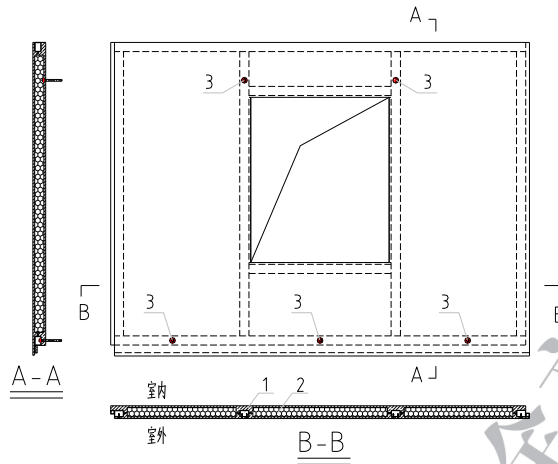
单龙骨整体预制复合墙板示意图
